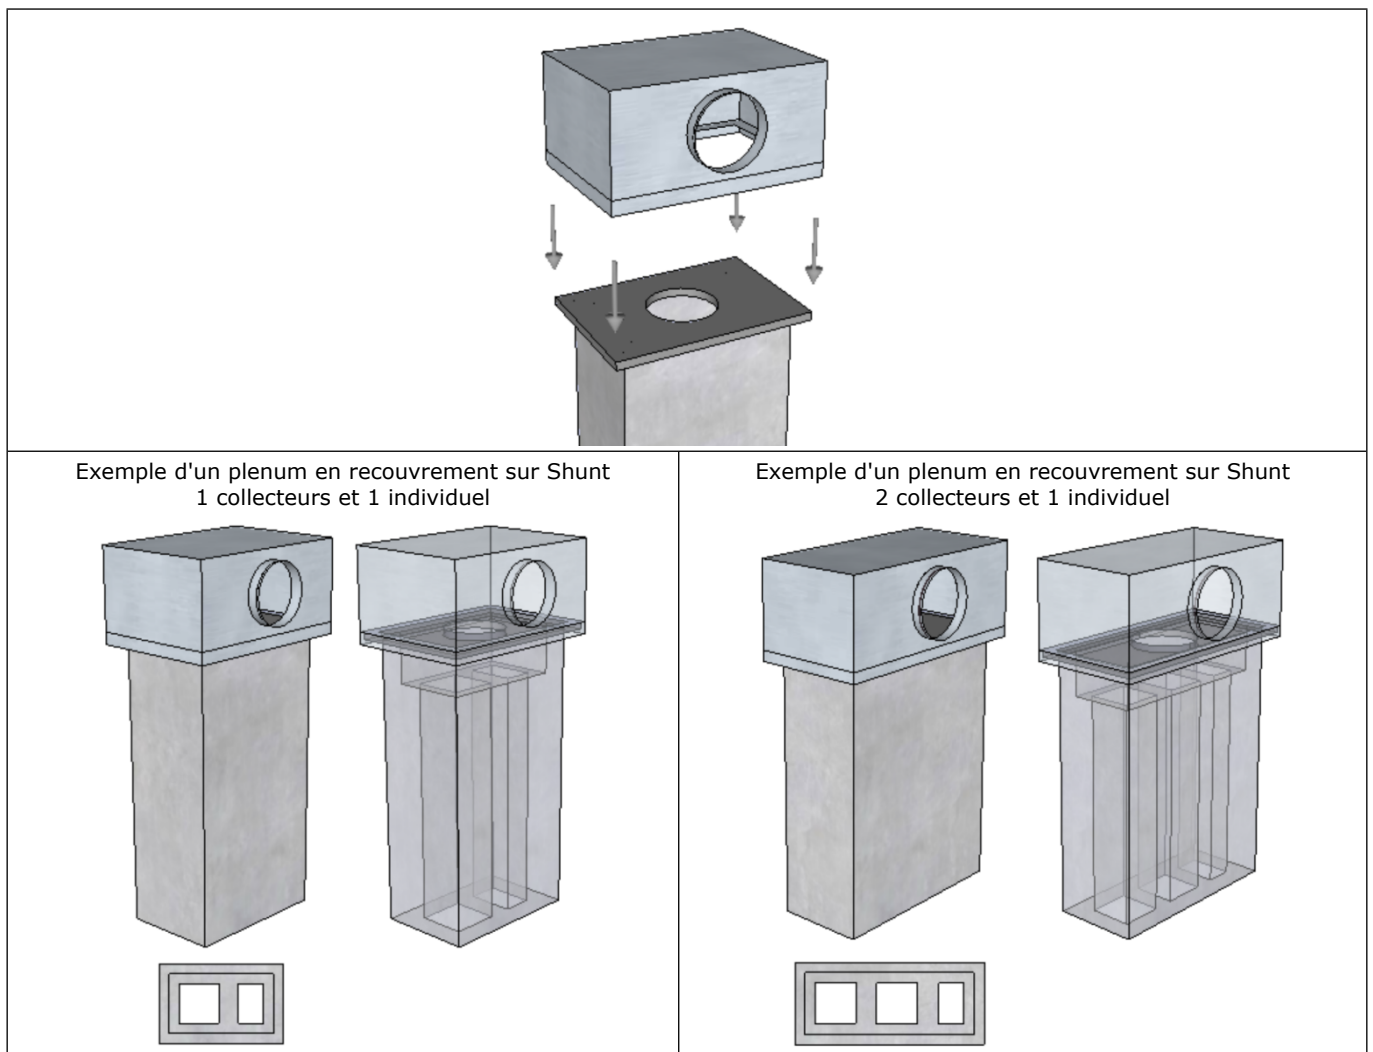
Schémas de principe d'un plenum de recouvrement avec goutte d'eau en cas de conservation de la dalle existante
